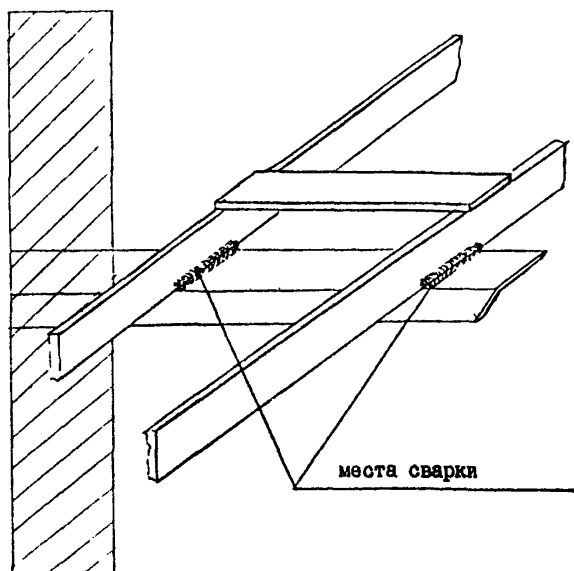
Крепление желоба к кронштейну или угольнику вдоль стены
